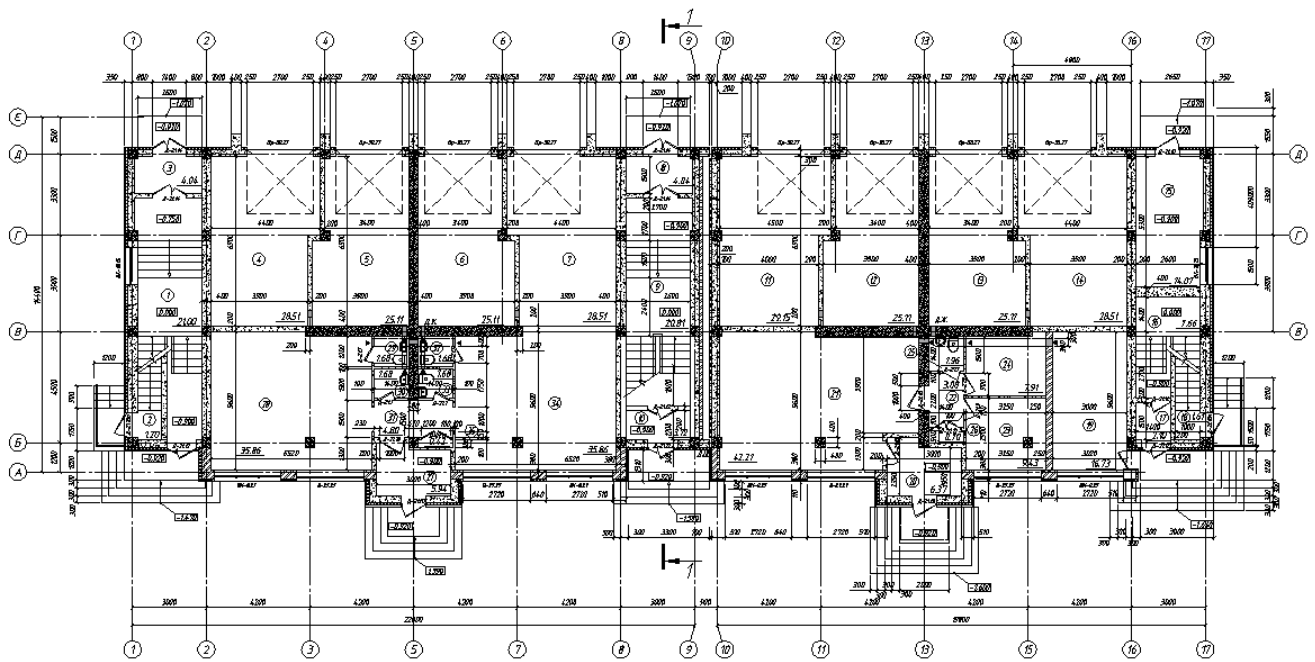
План першого поверху, на відм. - 0,900
